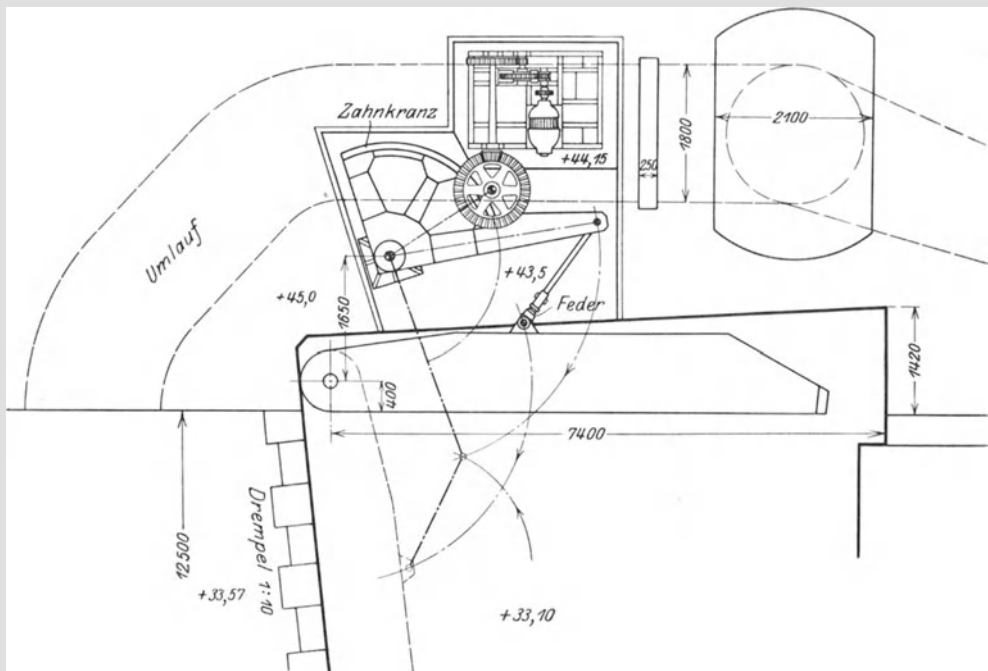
Stemmtorantrieb mit Kurbelradsektor. Entwurf der Freund-Stärkehoffmann-Maschinen A.-G. für Weserabstieg Minden, Schnitt und Grundriß. Maßstab 1:100.
